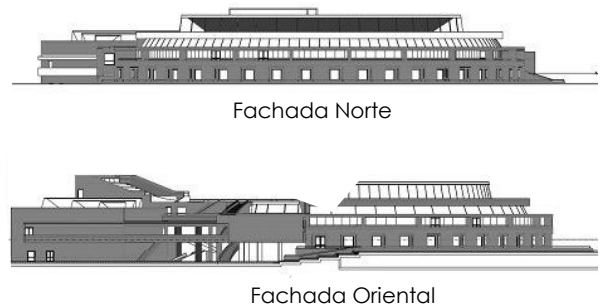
Imagen de la Biblioteca Pública Virgilio Barco), fachadas fuente Archdaily
